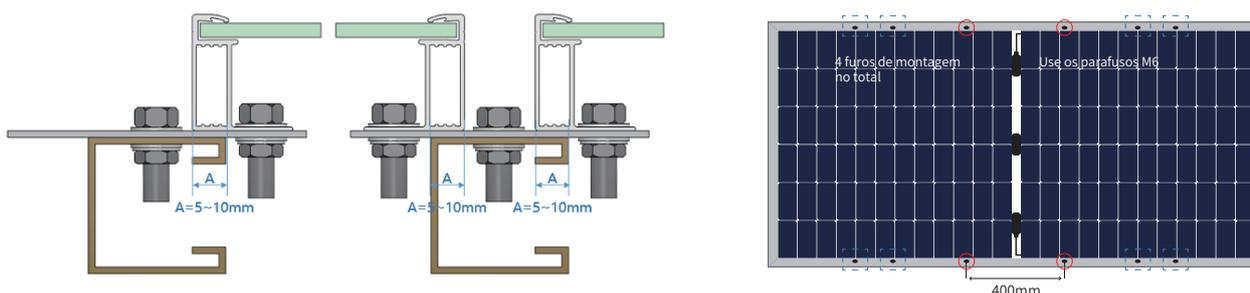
Diagrama de instalação do furo de montagem de componente lado duplo
